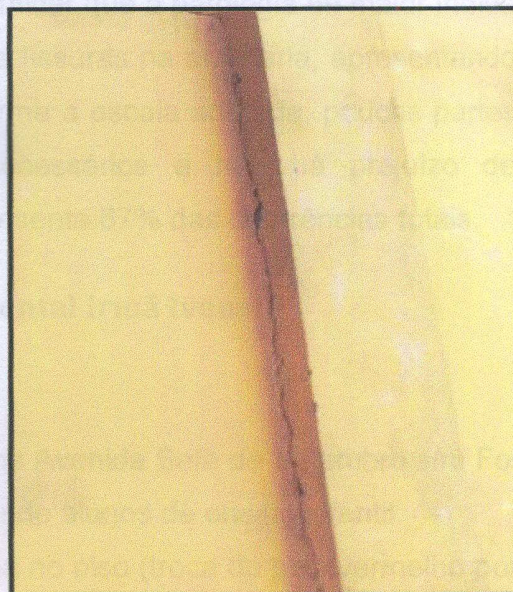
46.1 – Fissura entre a alvenaria e o pilar.
